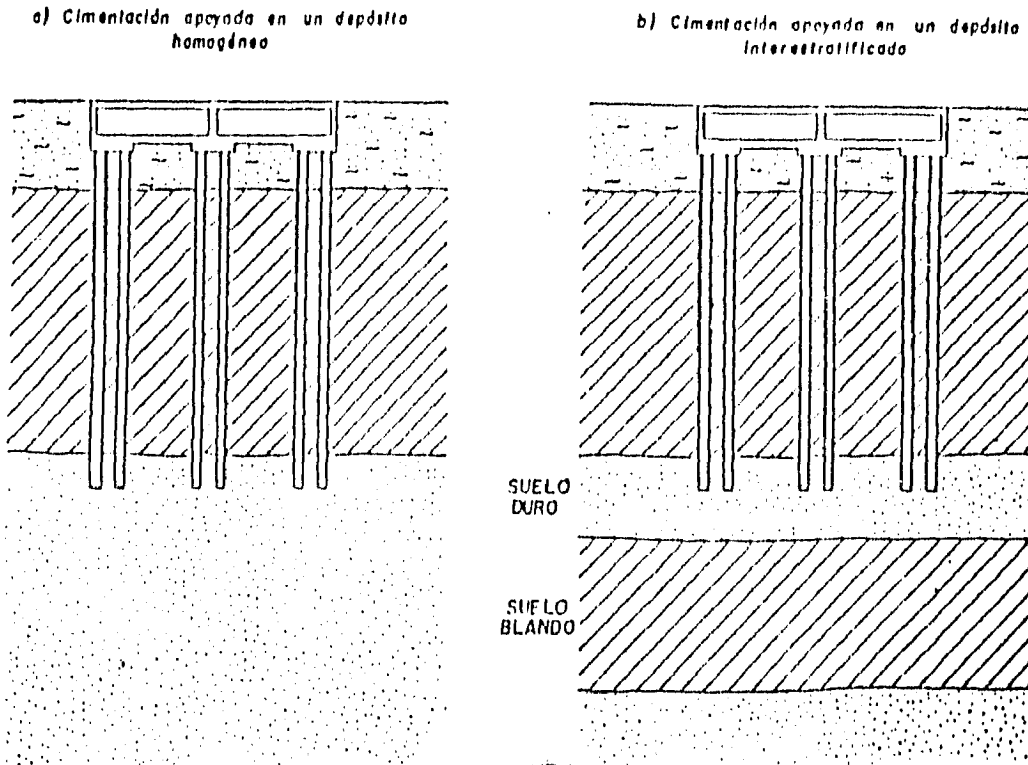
A CIMENTACIONES PROFUNDAS CON PILAS Y PILOTES DE PUNTA
